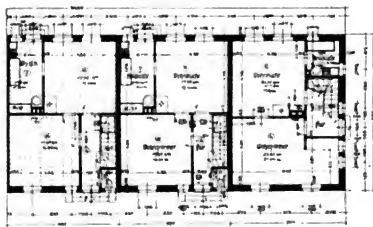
Grundriß zu Abb. 94. Erdgeschoß.
